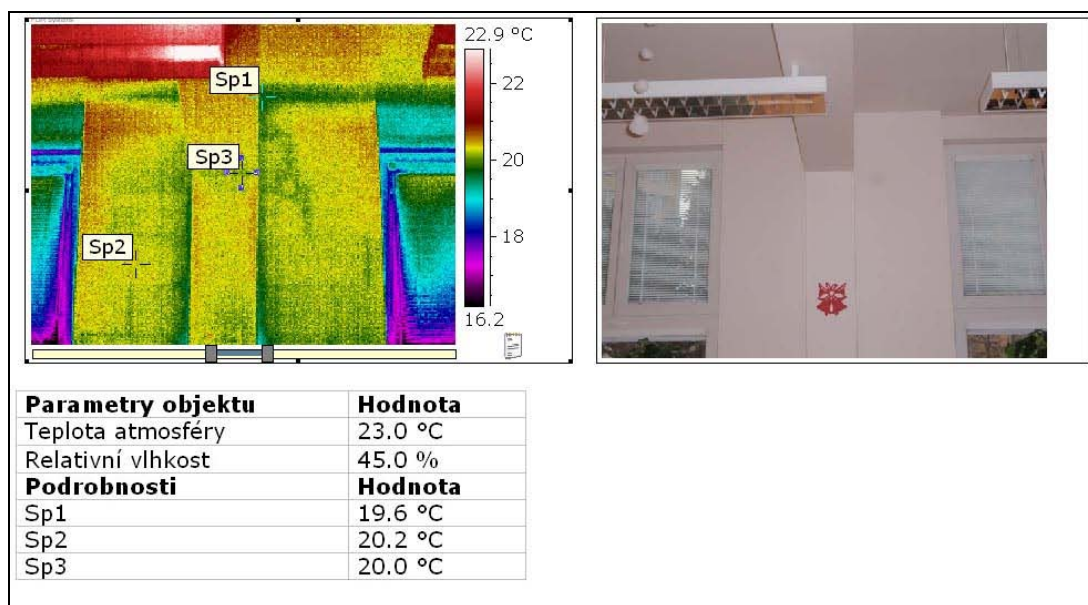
Termovizní snímek nezatepleného detailu (interiér)
